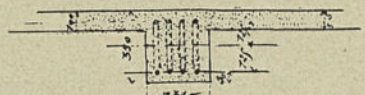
Reg-de-Chaussée - Poutre R (Fig 1)
